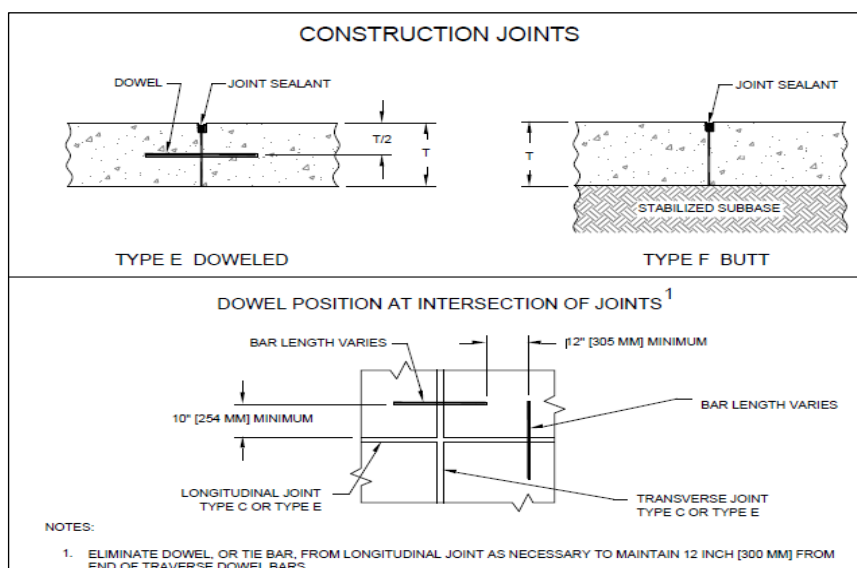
Esquema de las juntas de construcción de un pavimento de concreto hidráulico.
